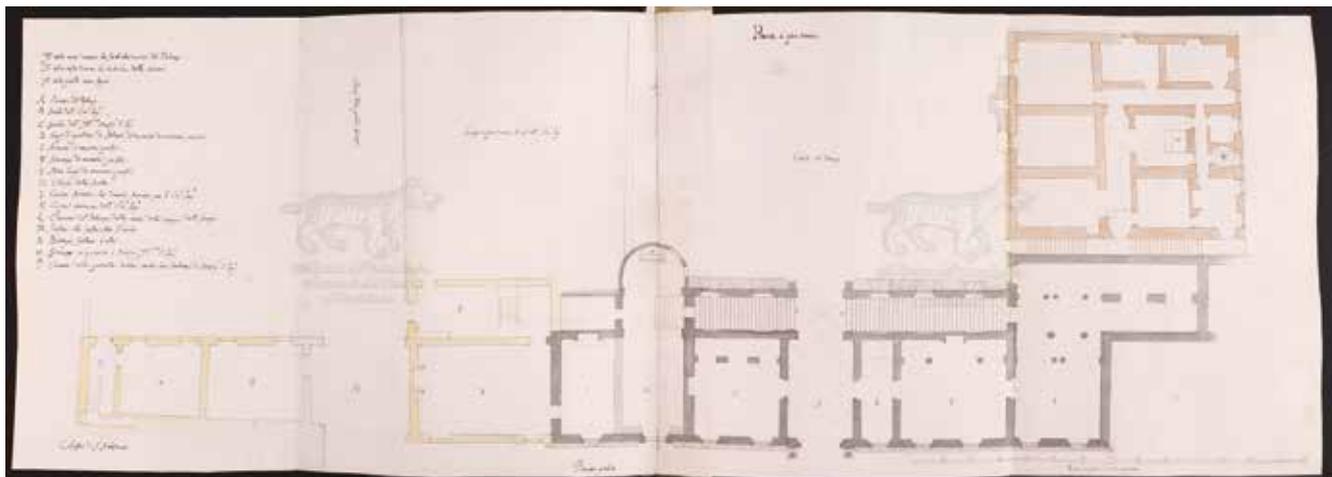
C.46 - BANLC, CORS. 34K-2, c. 26r – Ravenna, Anonimo, *Pianta piano terreno del palazzo Apostolico di Ravenna*, pianta (1696ca).
